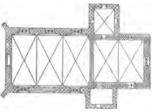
Rappin, Kirche, Grundriss 1:667.
